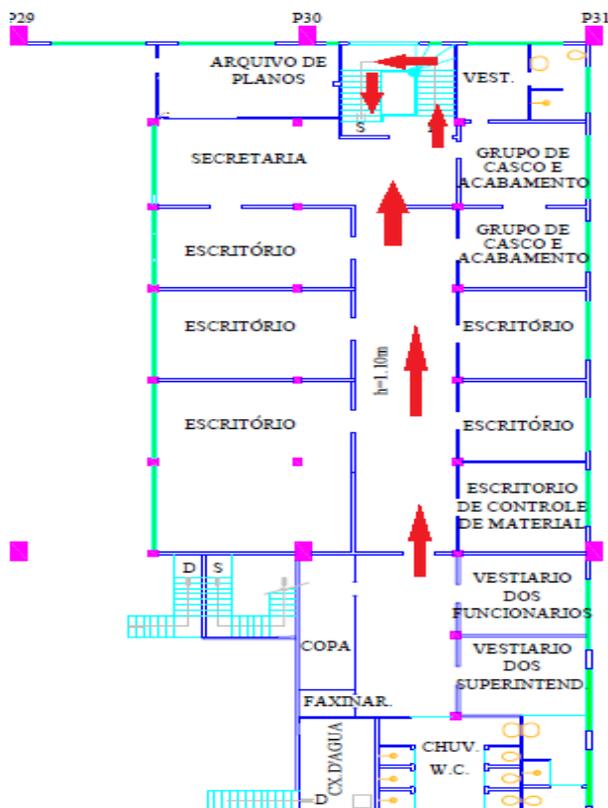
Rota de fuga do primeiro pavimento em direção ao térreo. Fonte: confecção própria.
